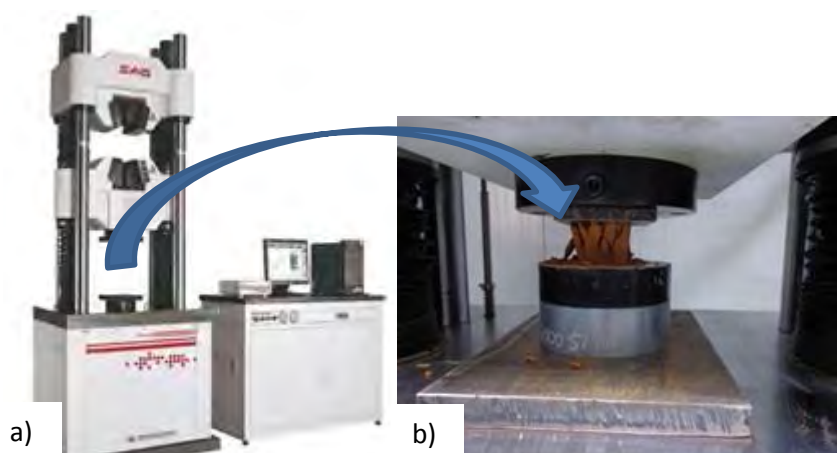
a) Masina de testat universală SANS cu echipamentul de comandă, control și măsurare, b) cub de cărămită după testare
